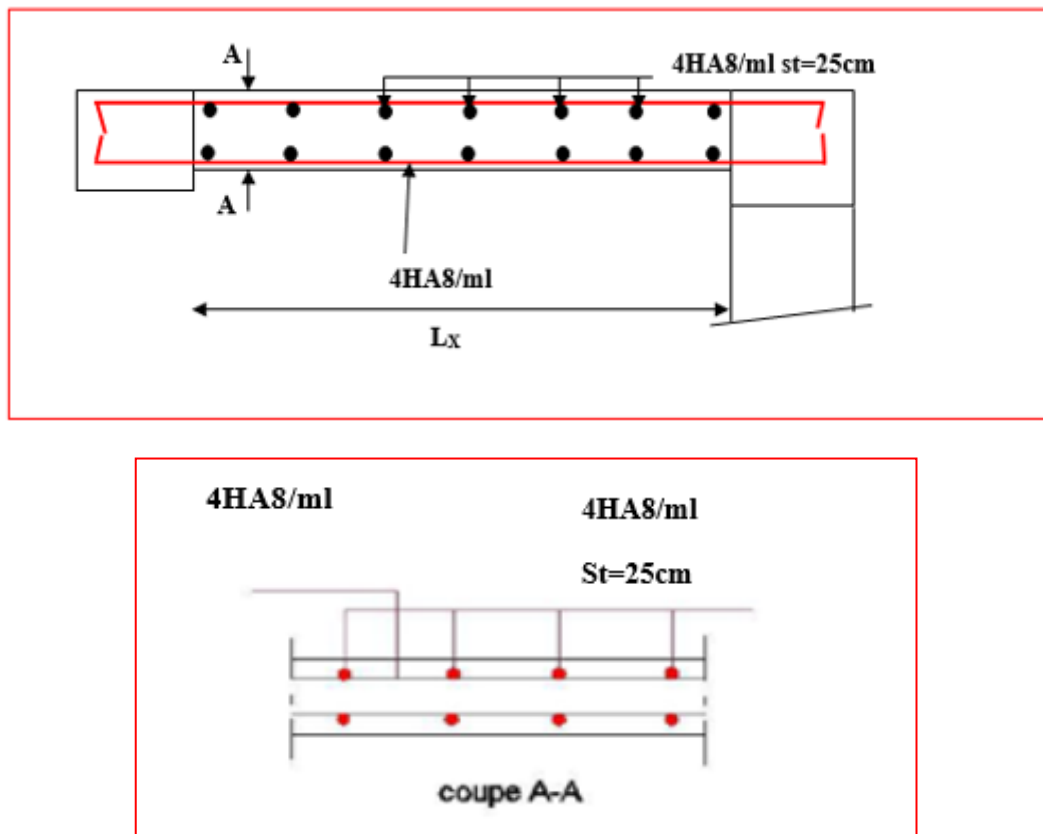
Schéma de ferrailage de dalle pleine 1 (balcon 1)
